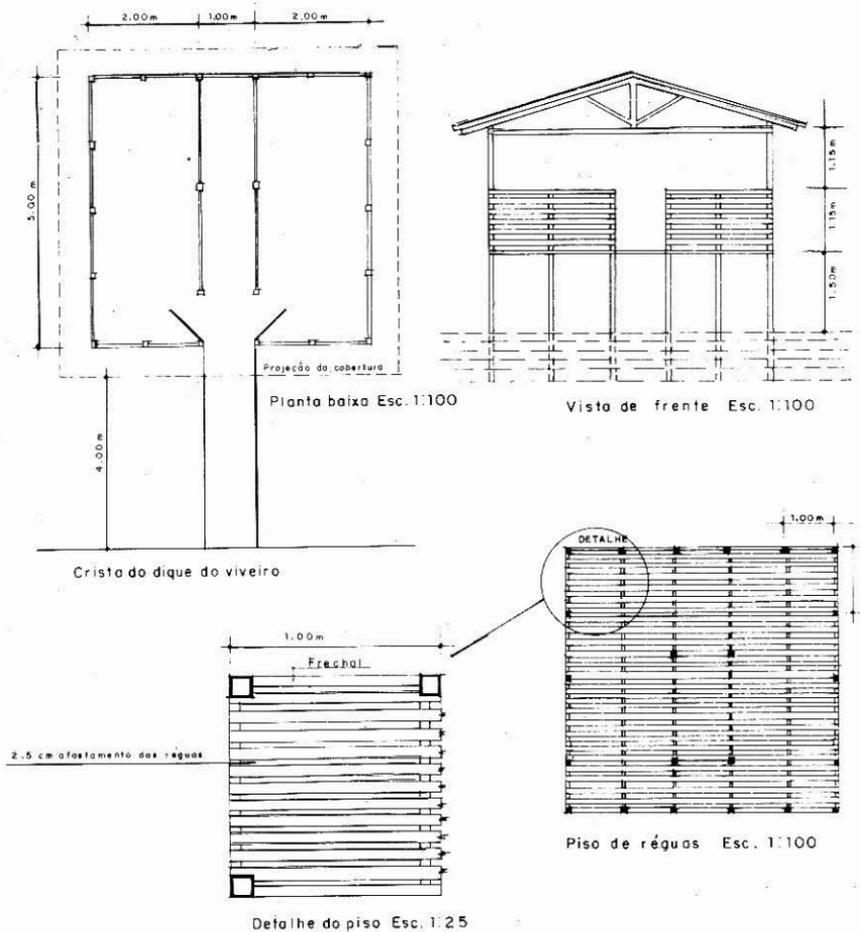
Planta da baia suspensa, com piso de madeira, para engorda de suínos.
